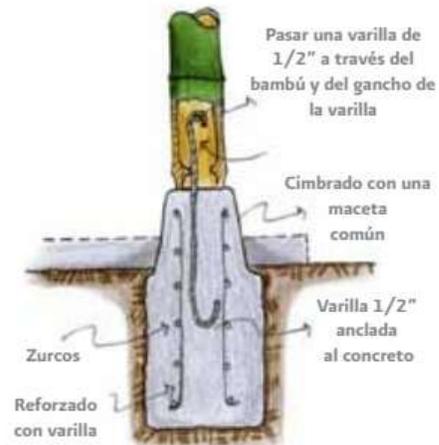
Anclaje de columnas, pies derechos. Elementos verticales a la cimentación con varilla de refuerzo y pasador.
